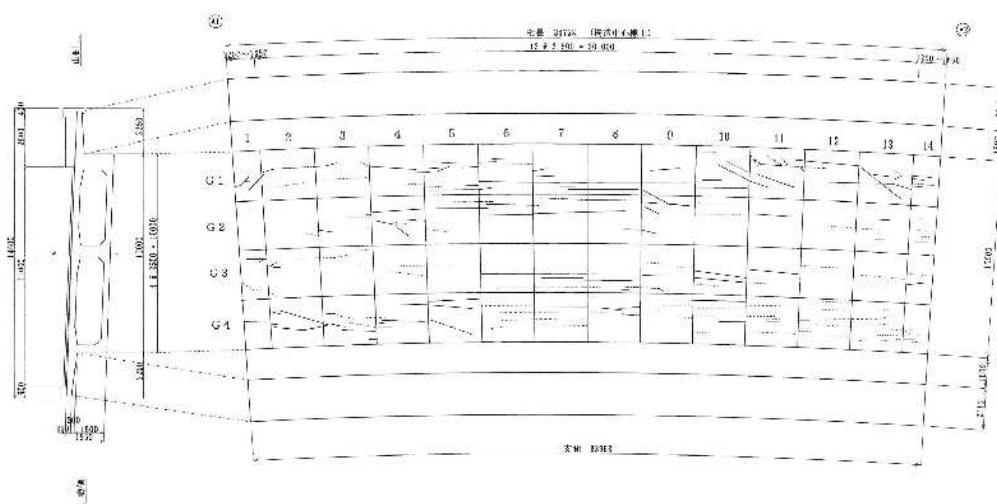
補修時のひび割れの状況（1999 年）
